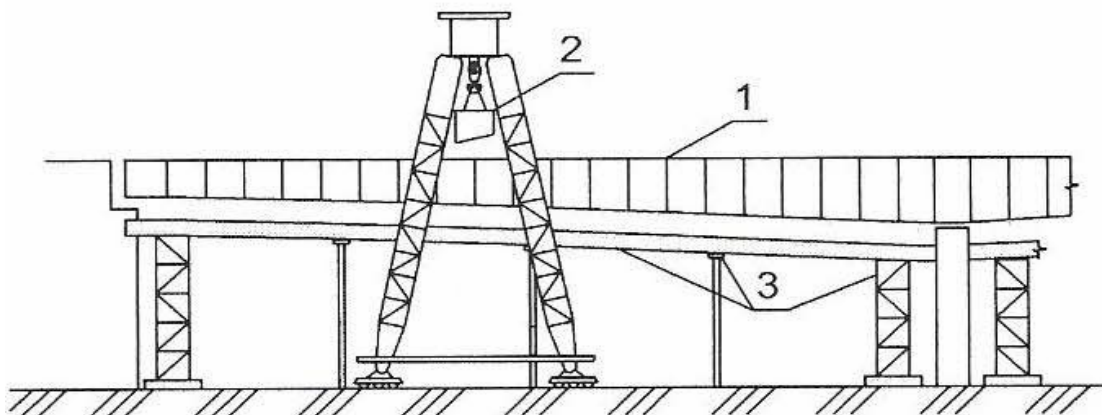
Схема монтажа транспортной галереи на промежуточной опоре: 1 – пролет галереи; 2 – кран монтажный; 3 – телескопические временные опоры и опорные узлы с домкратами.
